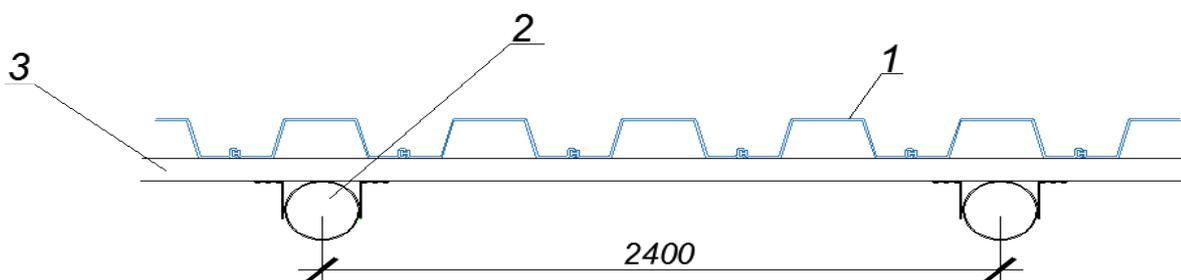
Конструкция шпунтовой подпорной стенки с опорной трубой
